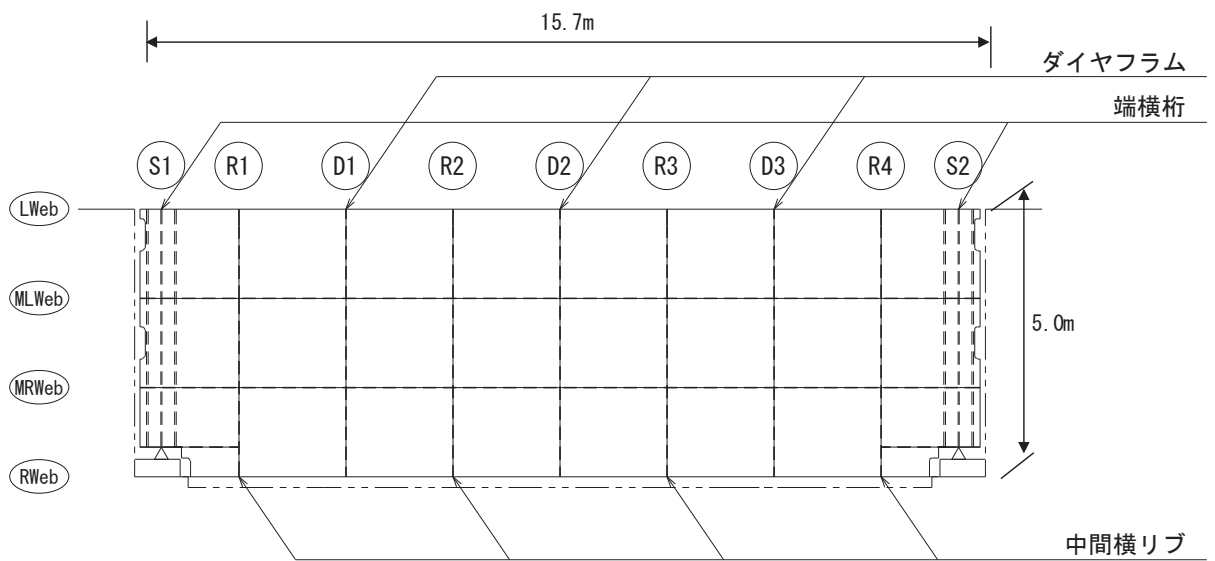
(2) 鋼製遮水壁（鋼桁 3） 平面図
